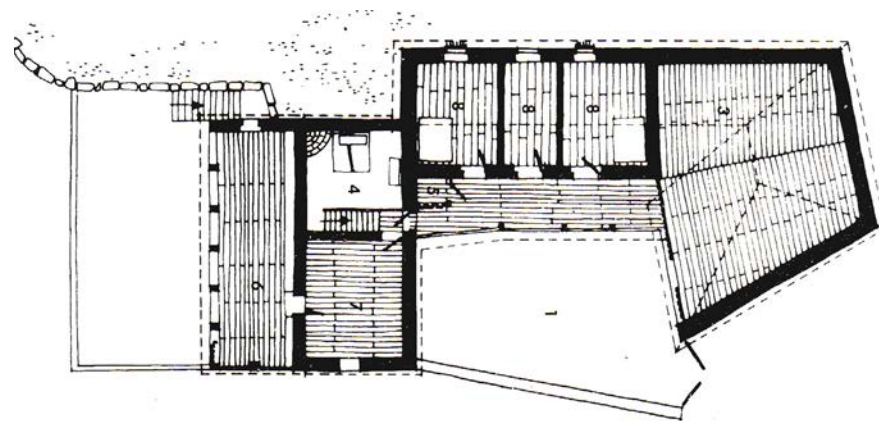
Anta. Planta do 2º piso da casa da lavoura. (Fonte: AAVV., 1º Vol., p.49, 1988)
